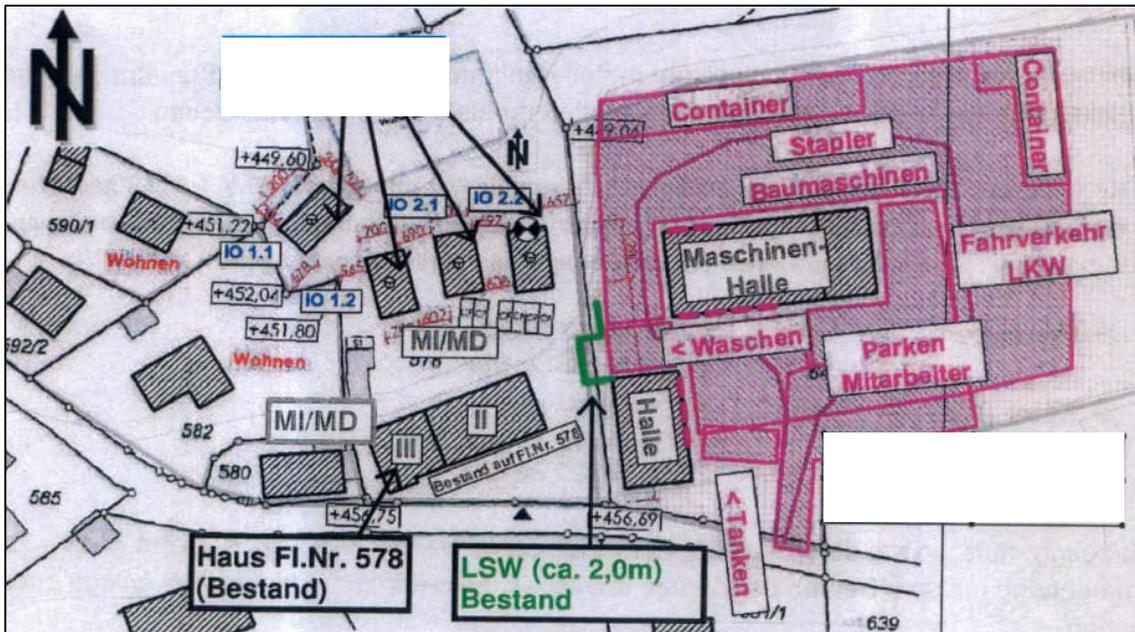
Lageplan mit Darstellung der genehmigten Wohnhäuser westlich des Geltungsbereichs /18/
